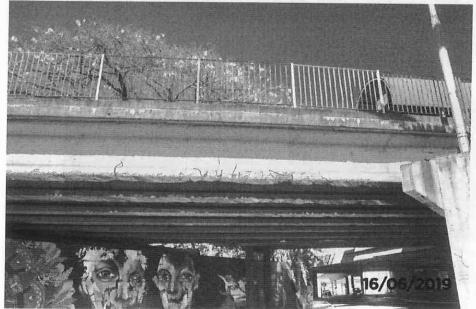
Detalhe das vigas com desplacamento de concreto, armaduras expostas e rompidas.
